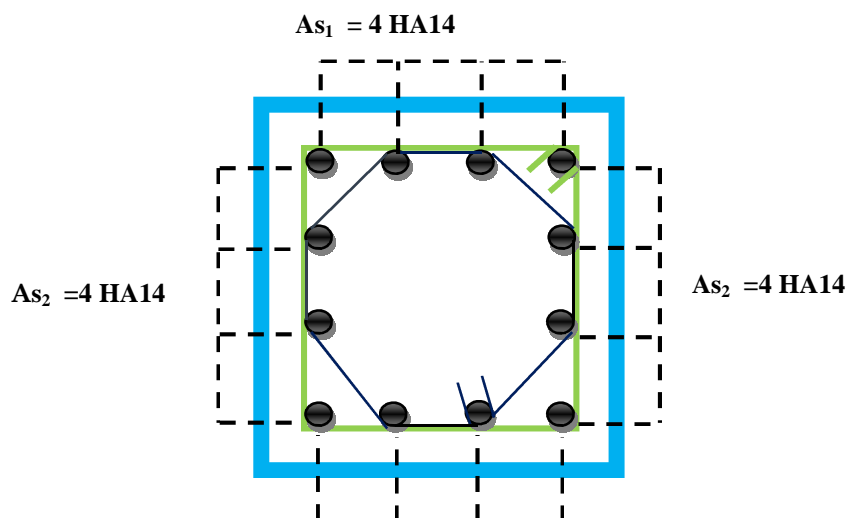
VI : Schéma ferraillage poteaux (45x45)
